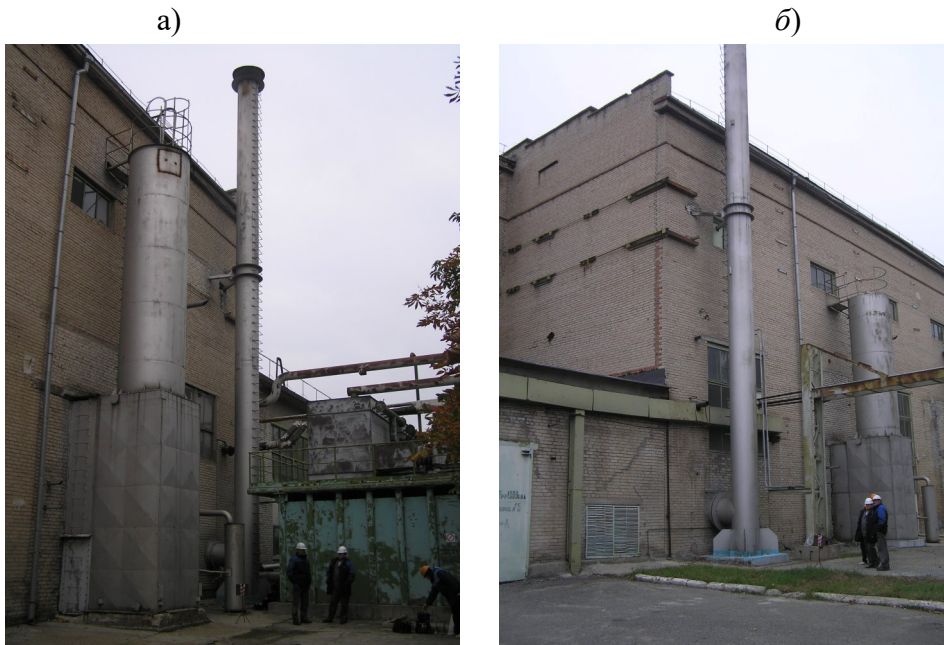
Общий вид металлических вытяжных труб высотой 19.9м кислородного цеха: труба компрессора 4М 10-50/70- (а); труба компрессора 4М 10-50/71- (б).
